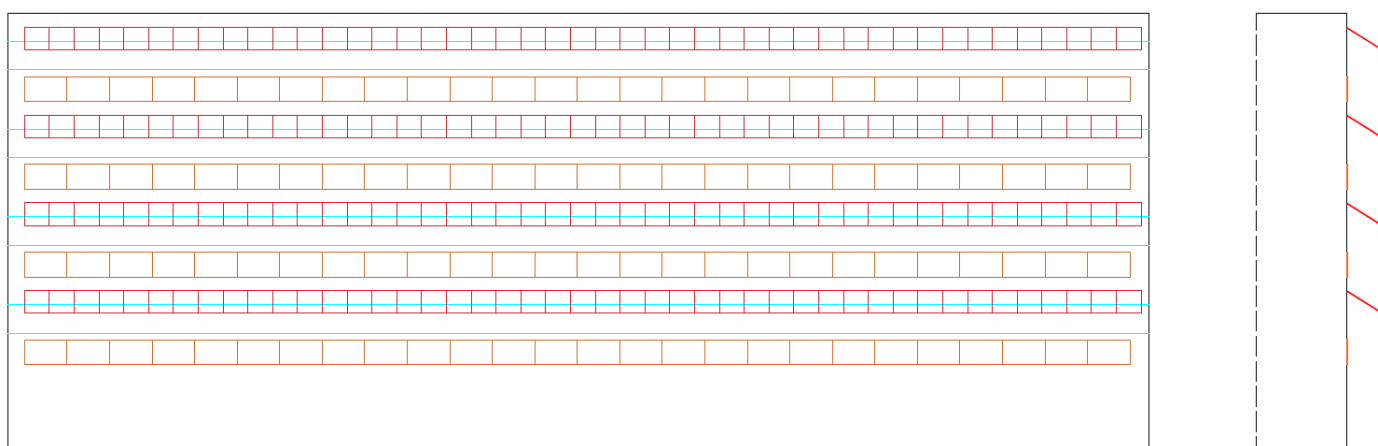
Vista frontal y de perfil de la disposición de los paneles en la fachada sureste del edificio.
